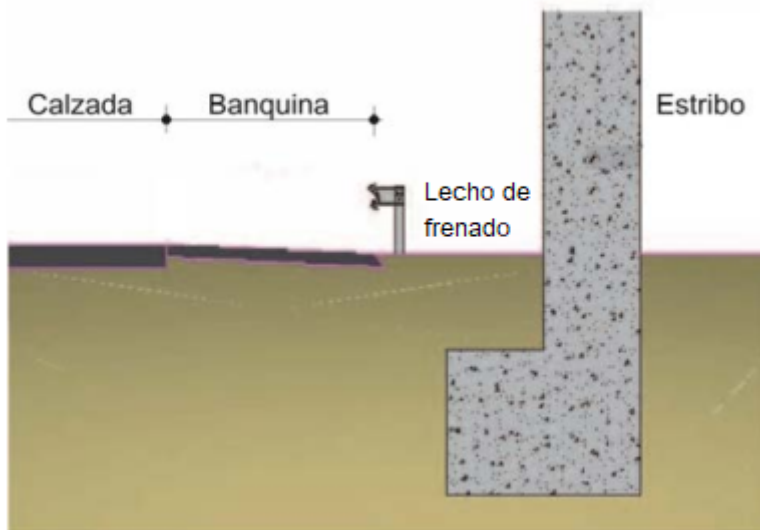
Vista en corte de la disposición de las defensas de los estribos.
